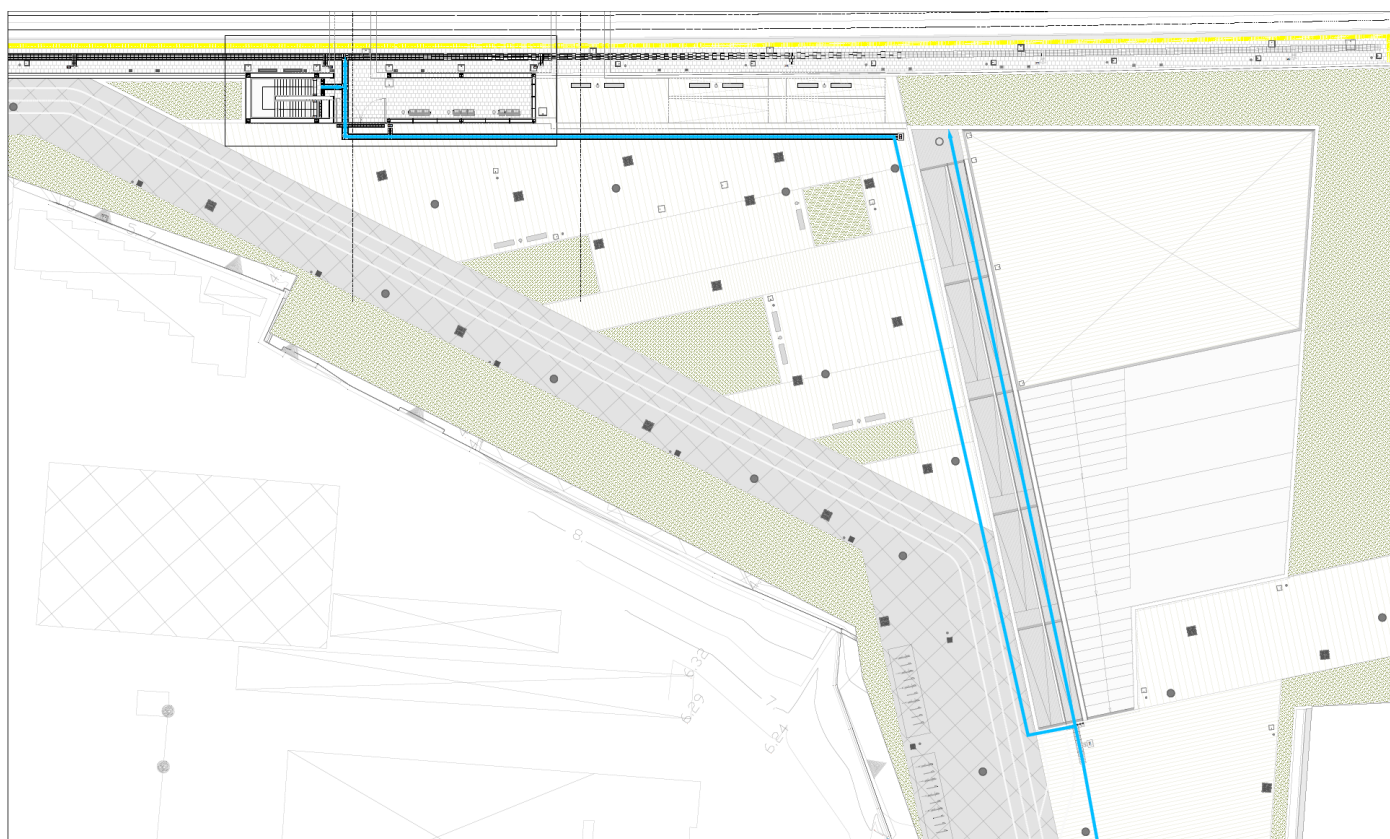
Pianta quota banchina con individuazione del PPO - Stralcio 1 di 2
